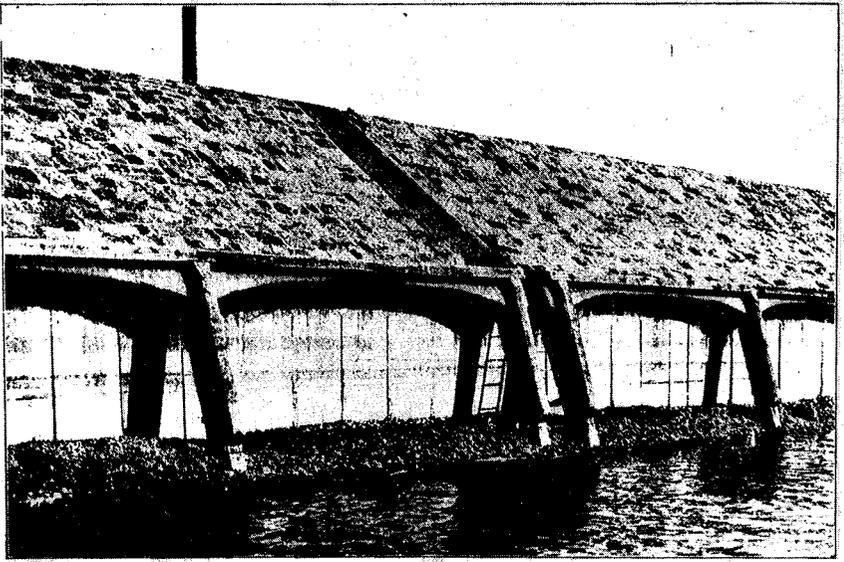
Böschung mit Betonbohlwerk in der Ansicht
